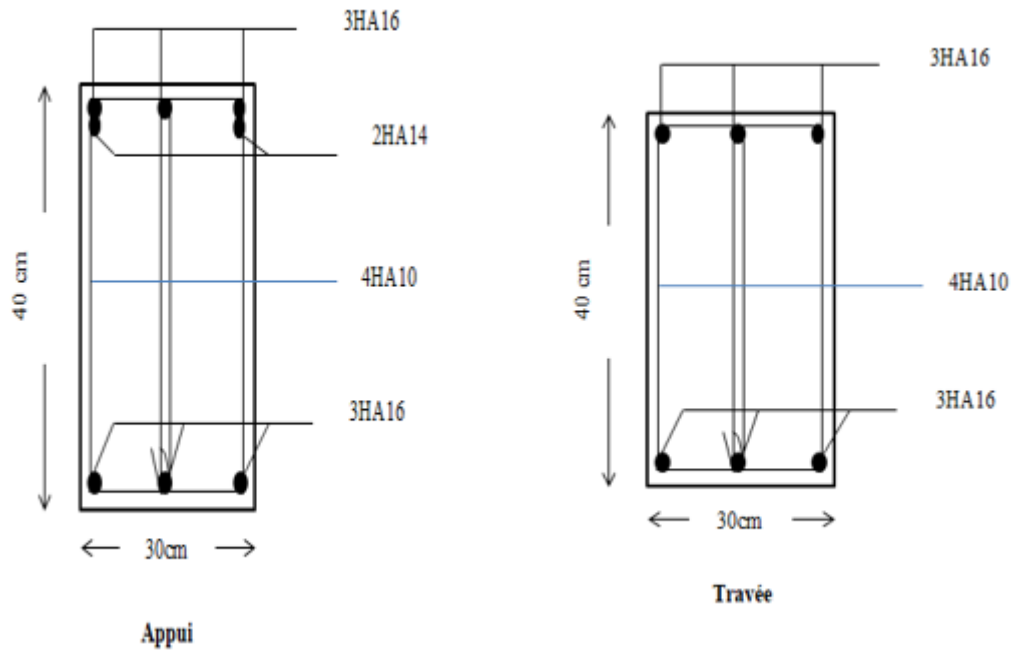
Schéma de ferrailage des poutres non porteuses du 7^{ème} étage (TERRASSE).
